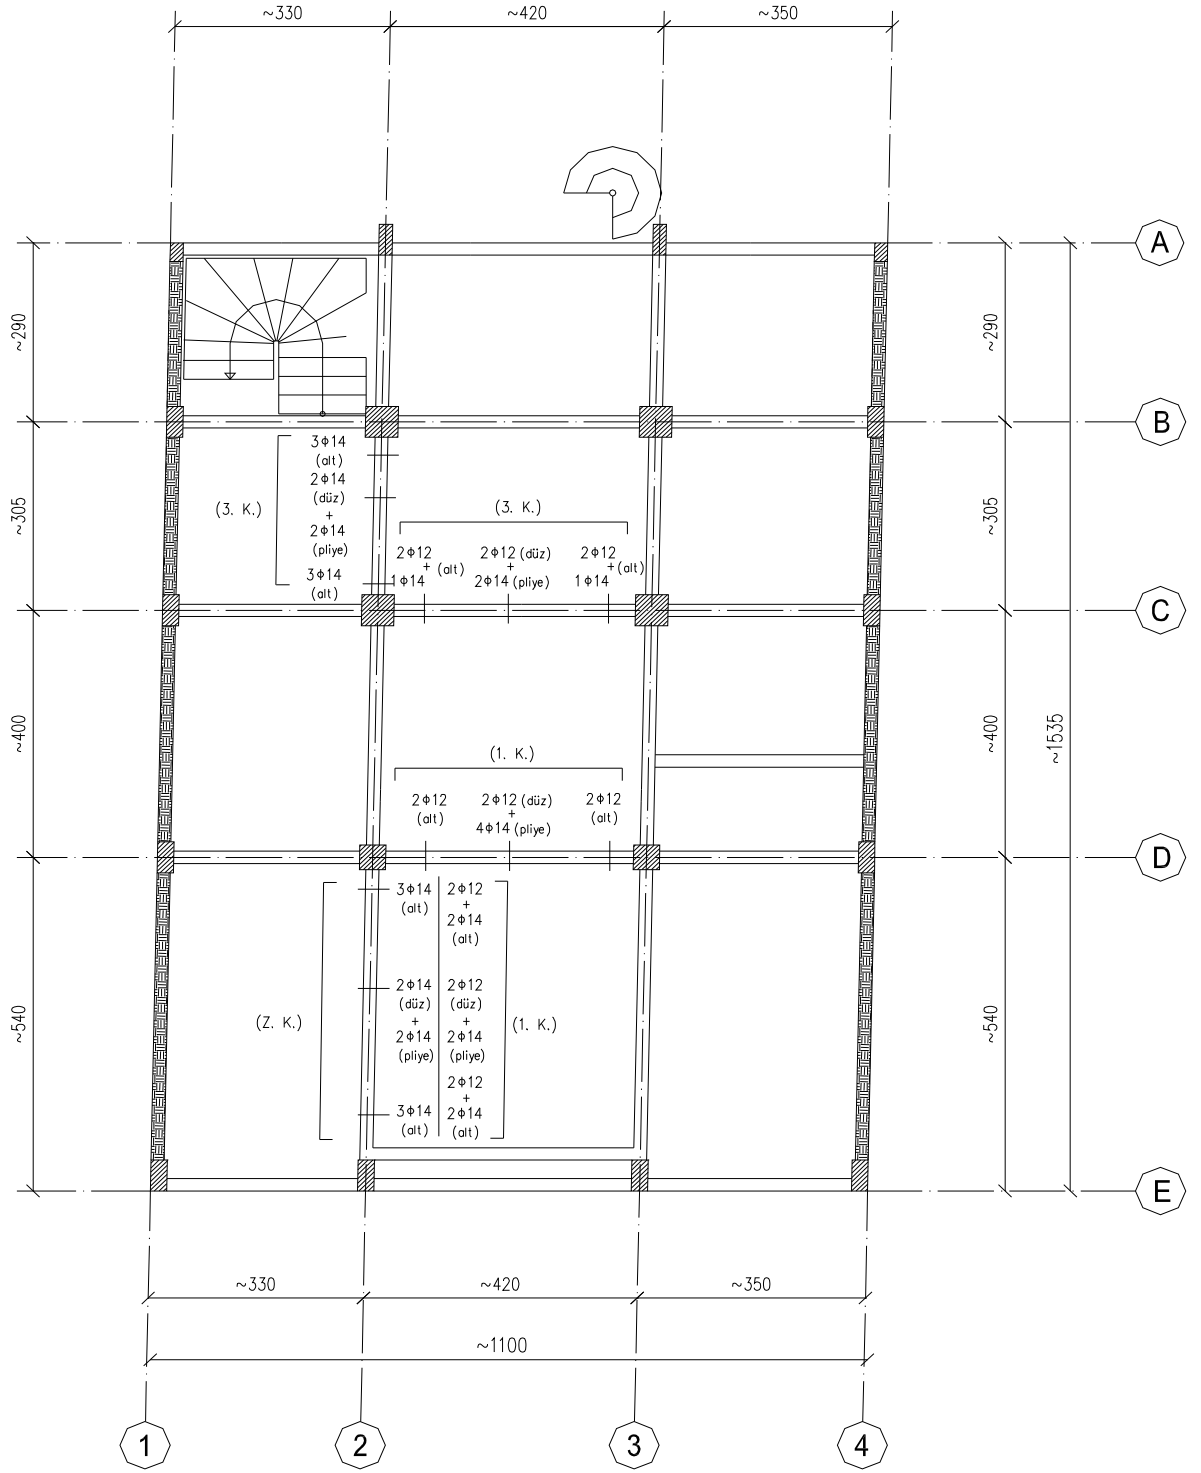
Mevcut yapı 2. kat tavanı kalıp planı
